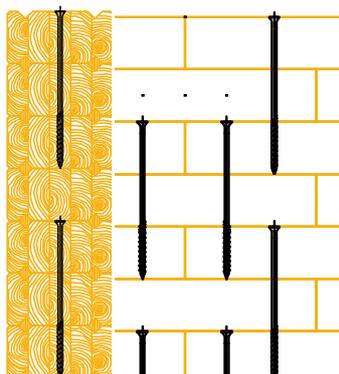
Corte longitudinal e transversal de um pano de parede de alvenaria estrutural em madeira.
